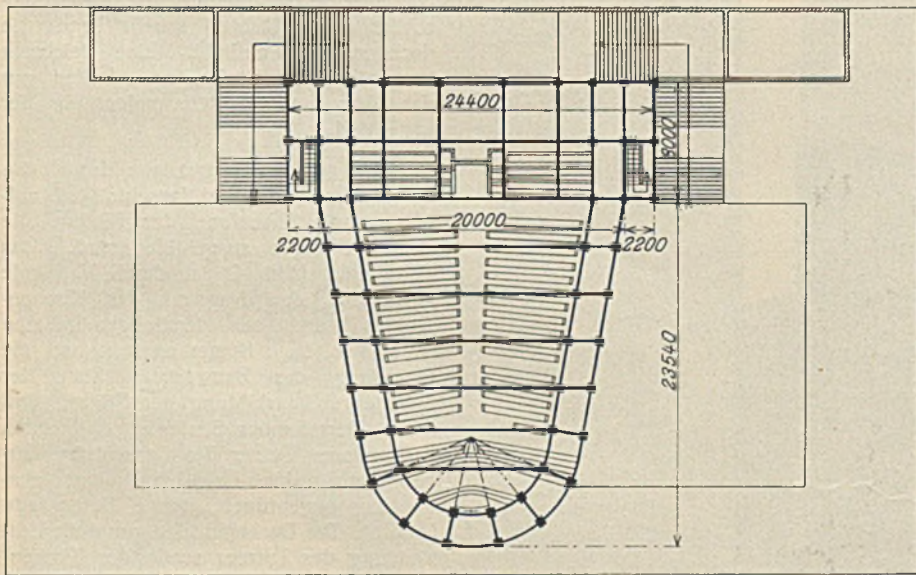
Grundriß des Kirchenschiffes mit Trägerlage.
